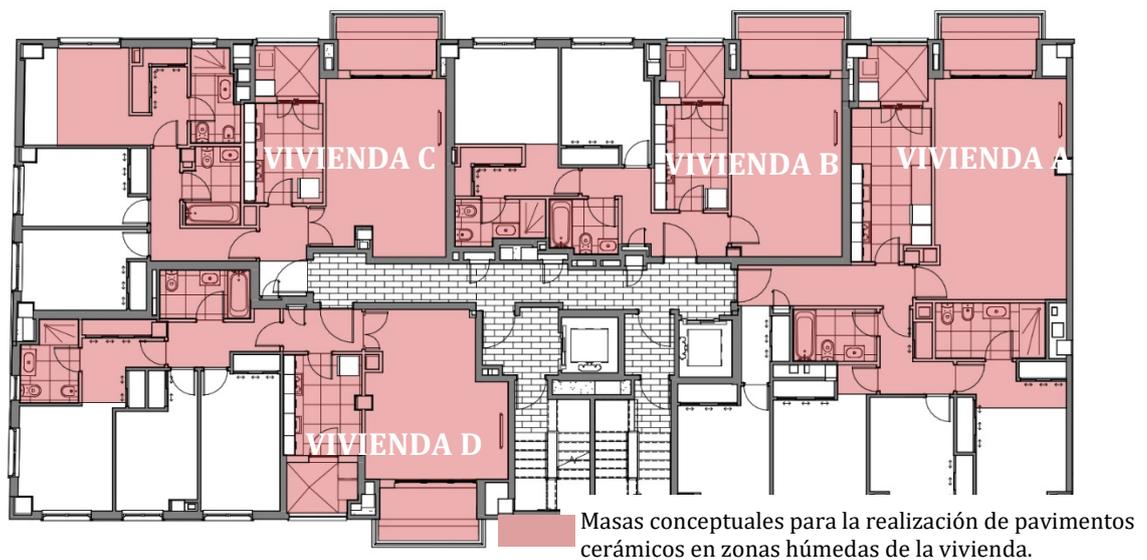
Masas conceptuales que representan el área que ocupa el equipo de trabajo para la realización de pavimentos cerámicos en las zonas húmedas de las viviendas en una planta tipo.
